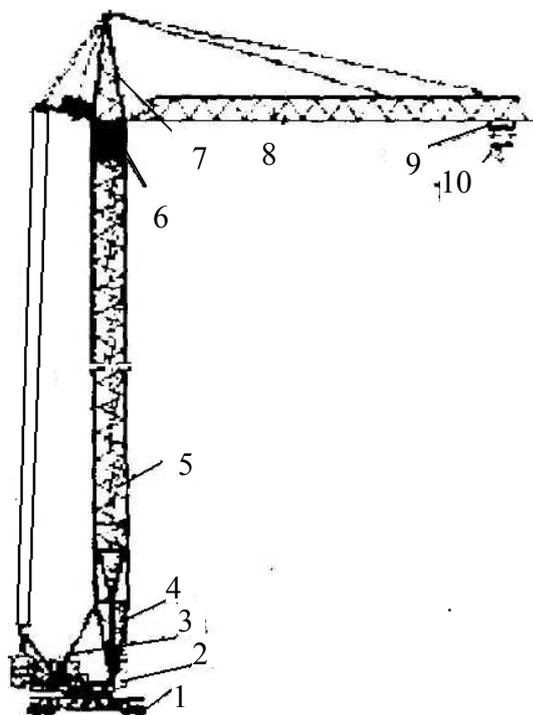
Башенный кран: 1 – ходовое устройство; 2 – поворотная платформа; 3 – балласт; 4 – портал; 5 – башня; 6 – кабина крановщика; 7 – оголовок; 8 – стрела; 9 – каретка; 10 – крюк
